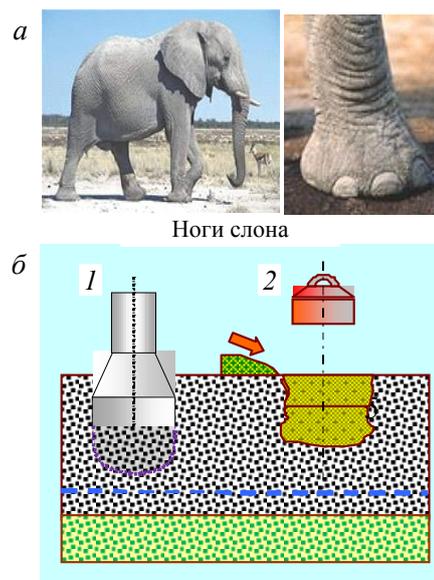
а – Слон и его нога; б – аналоги его тяжелой поступи – фундамент с уширенной подошвой (1) и уплотнение грунта (2)
